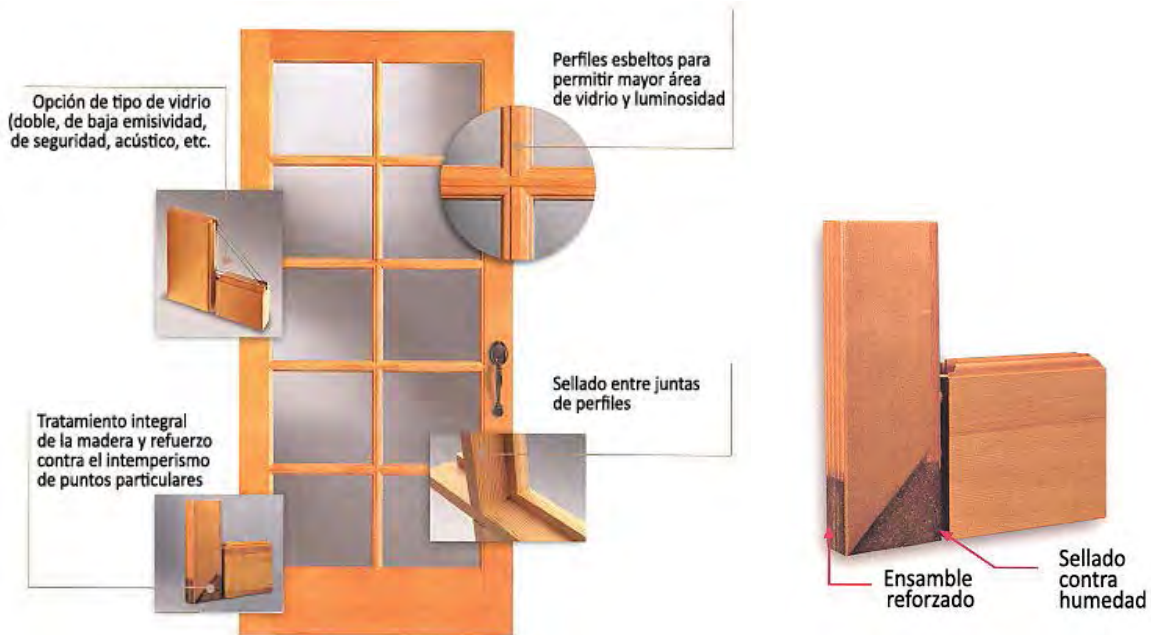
DETALLES A CUIDAR EN PUERTAS EXTERIORES DE MADERA
